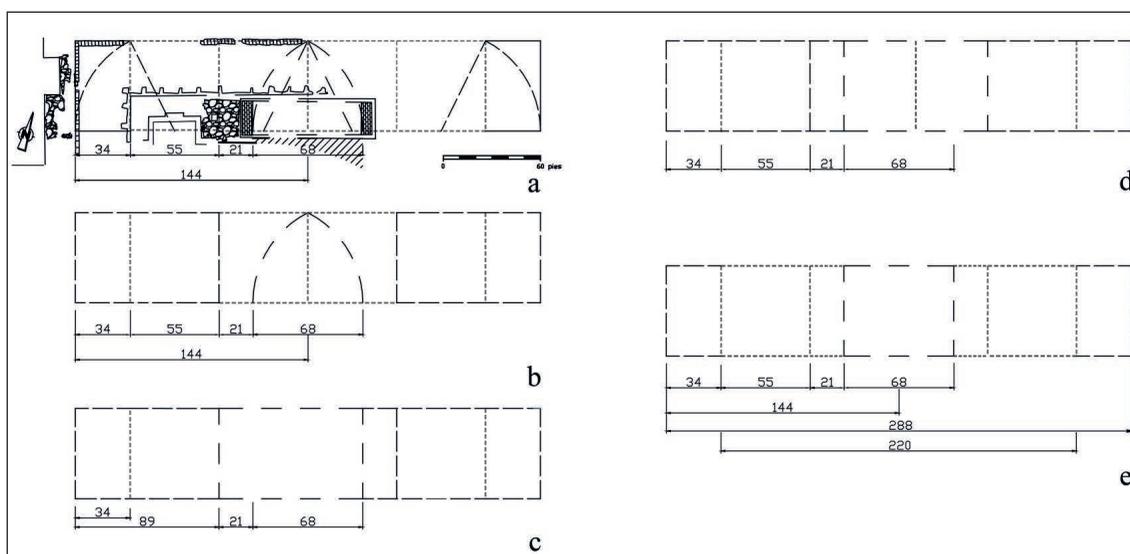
Desarrollo de las estructuras principales de la zona del área sacra.
